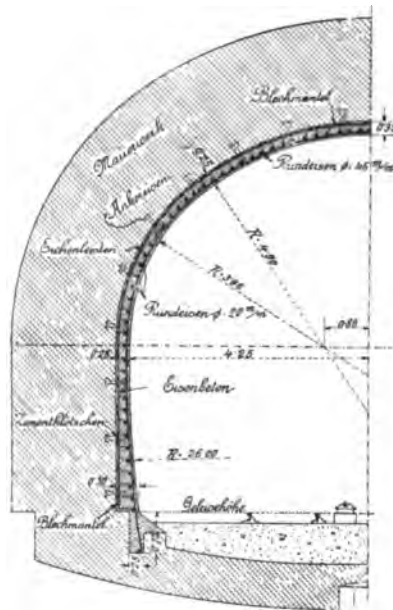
Querschnitt des rekonstruierten Meudontunnels.
